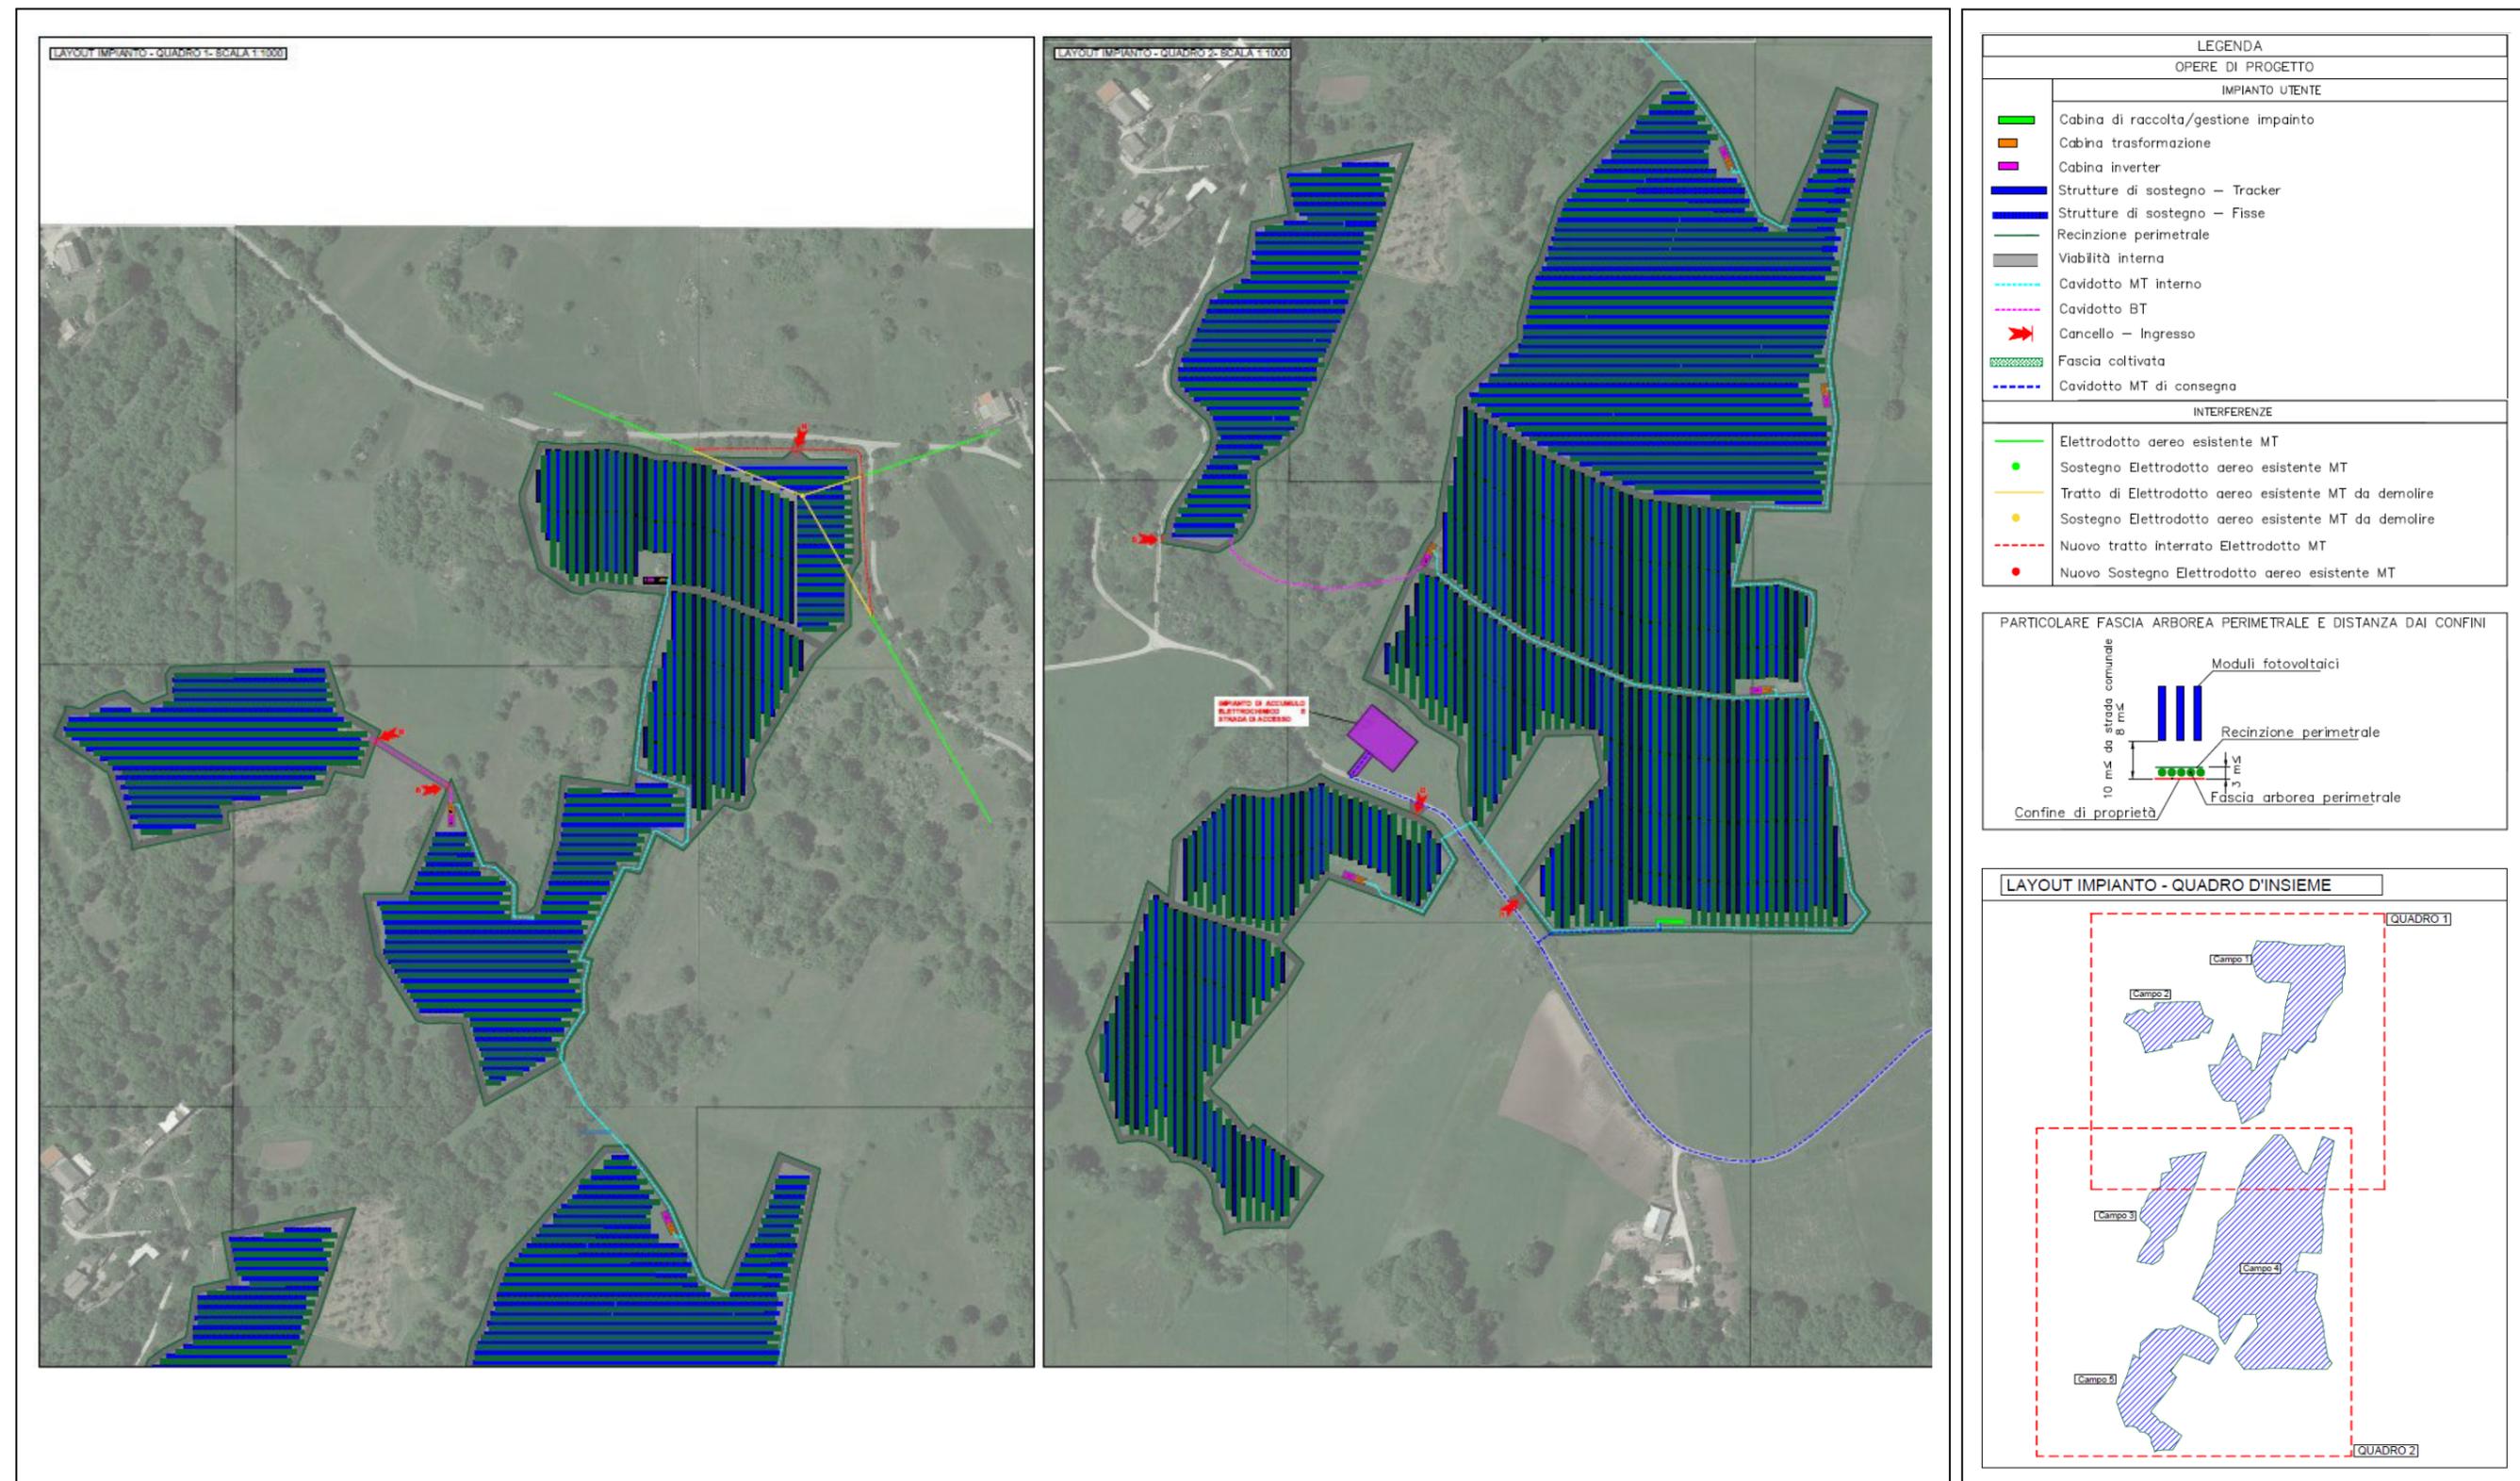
Layout di progetto - impianto di generazione - su ortofoto
